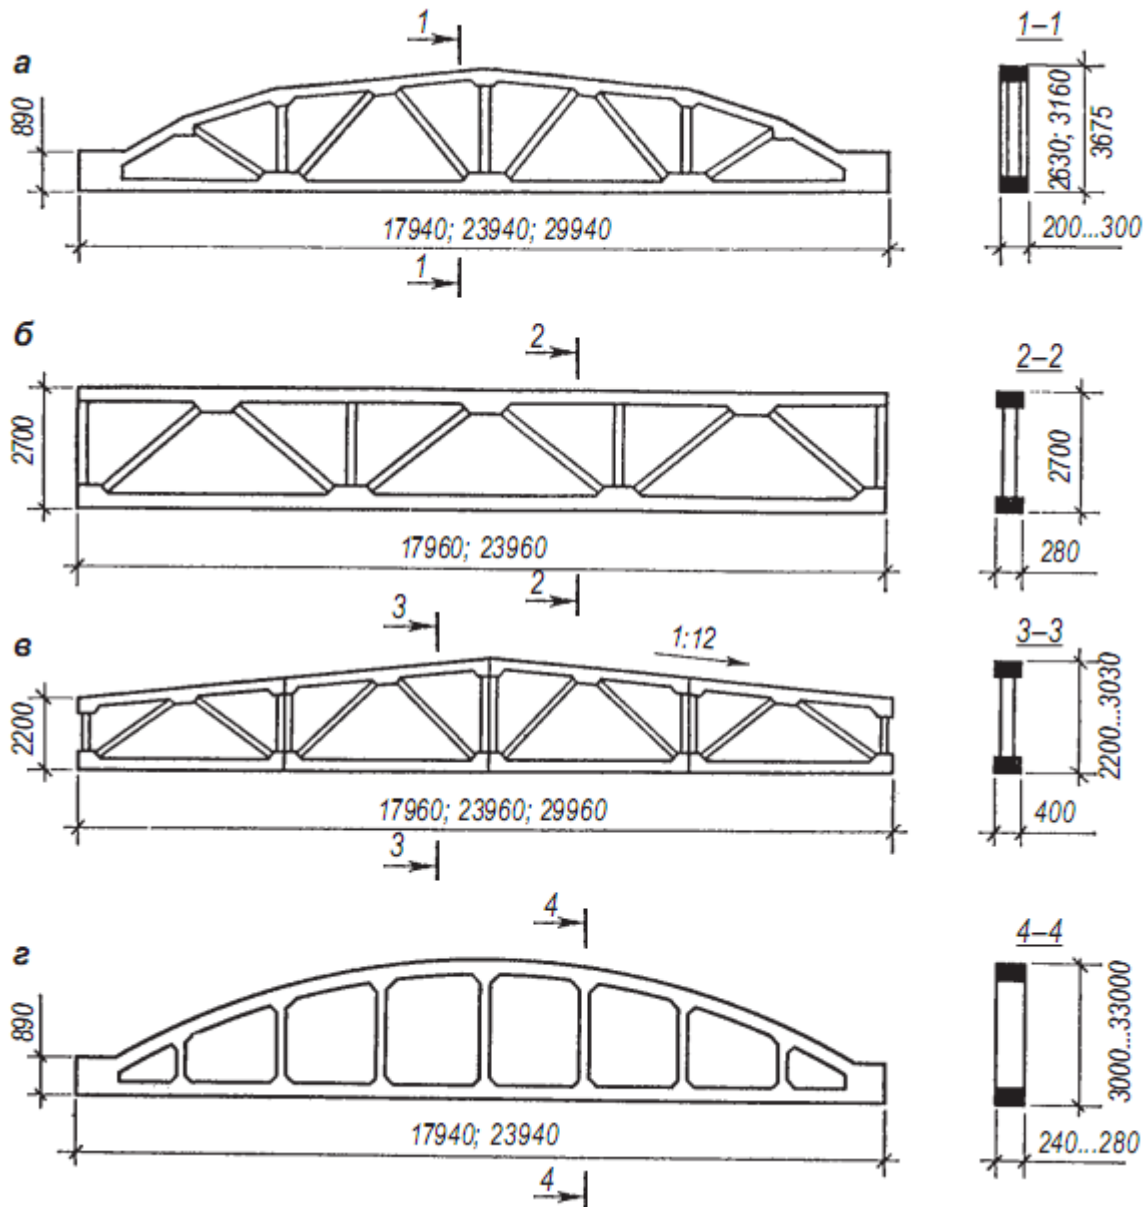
Залізобетонні кроквяні ферми покриття: а – сегментна; б – з паралельними поясами; в – полігональна; г – аркова безрозкісна
